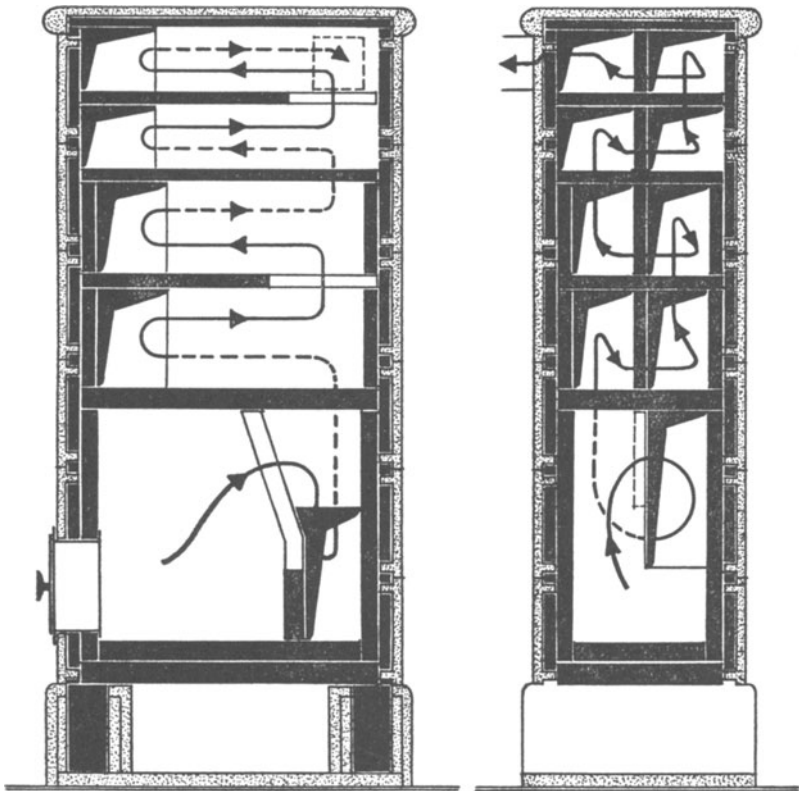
Holzdauerbrand-Kachelofen; Heizgasführung.
